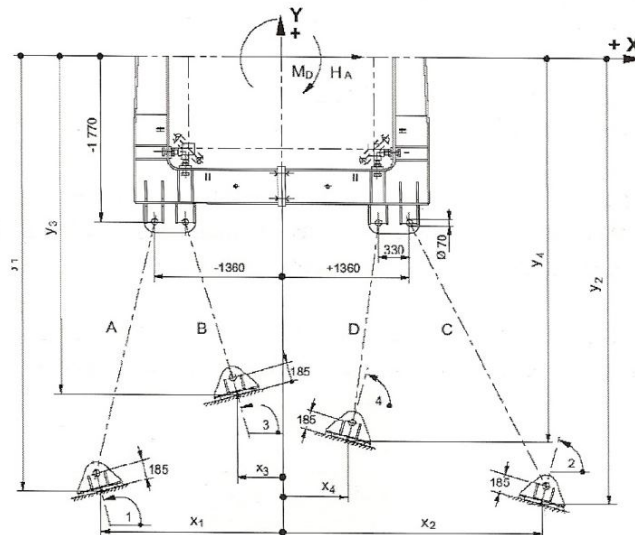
Ligação com 4 barras e 4 ancoragens (Manitowoc, 2010)
